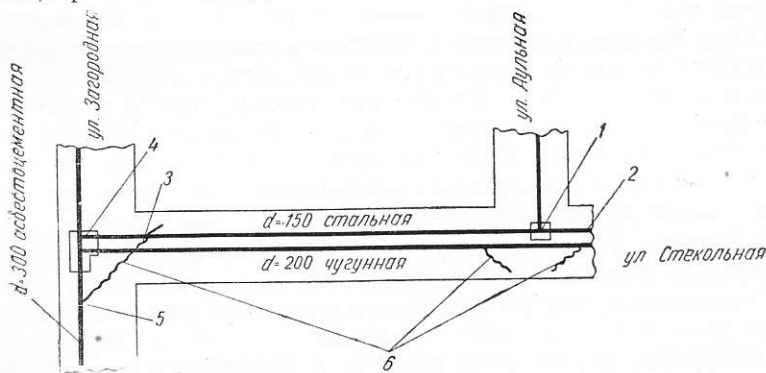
Схематический план повреждений труб и фасонных частей водопровода по Стекольной ул.
